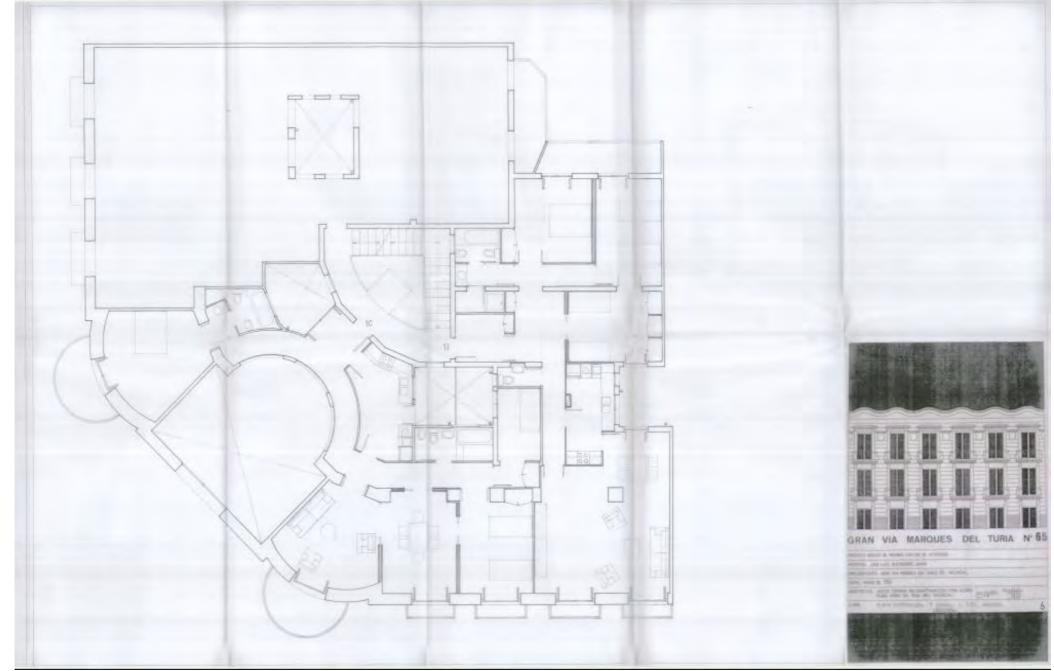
Planta primera estado proyectado, rehabilitación 1985
